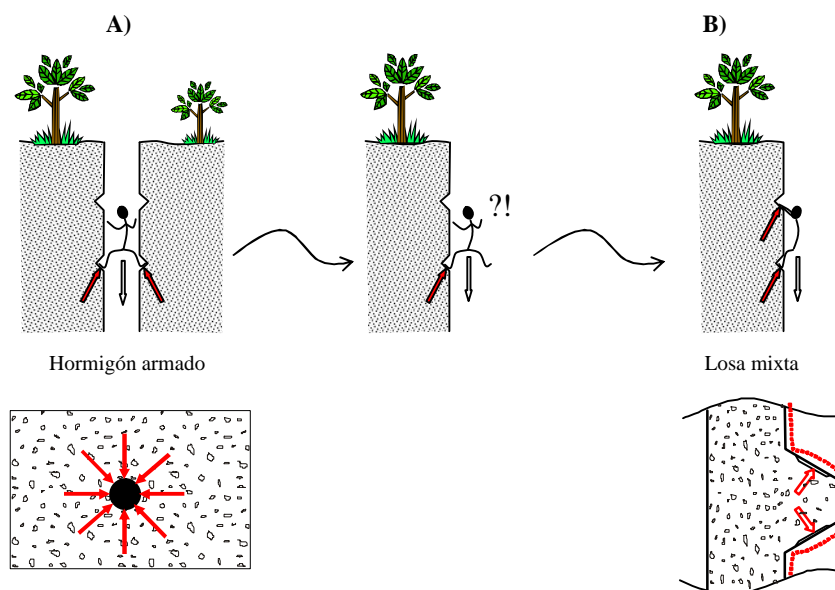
Analogía del comportamiento del hormigón armado y las losas mixtas
